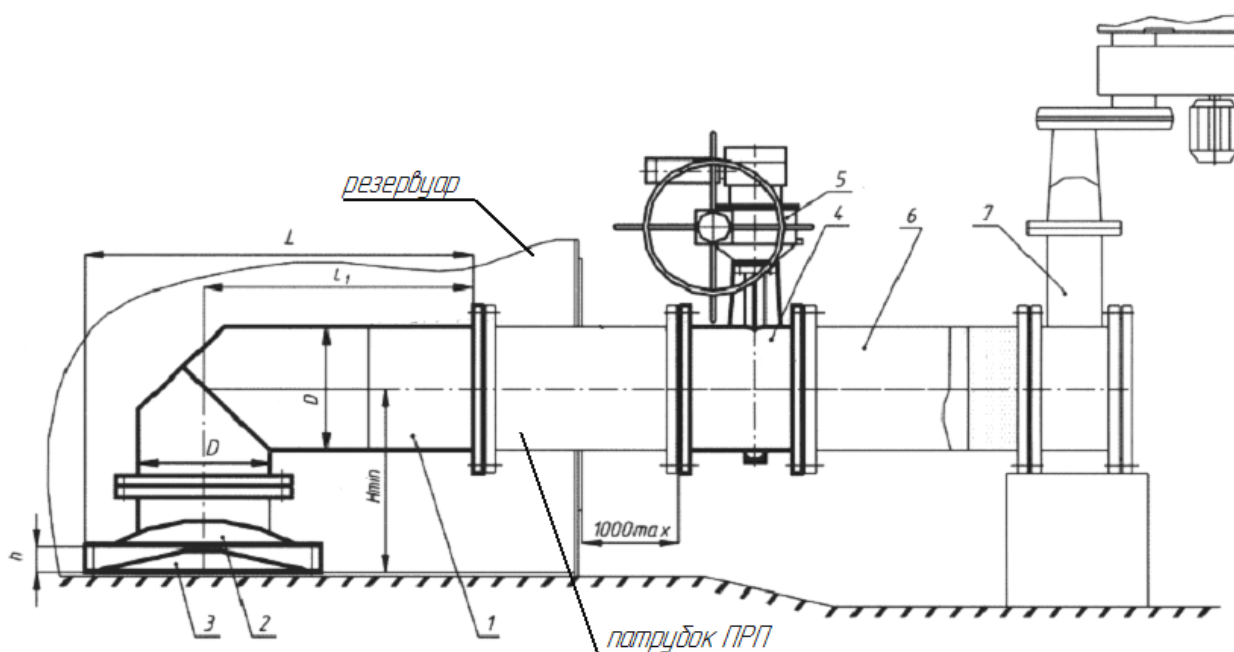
Общий вид приемо-раздаточного устройства ПРУ:
